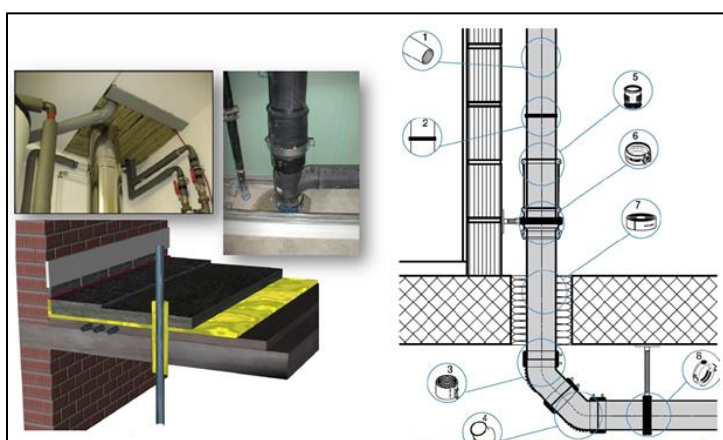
Passage mural ou au sol pour les installations sanitaires
